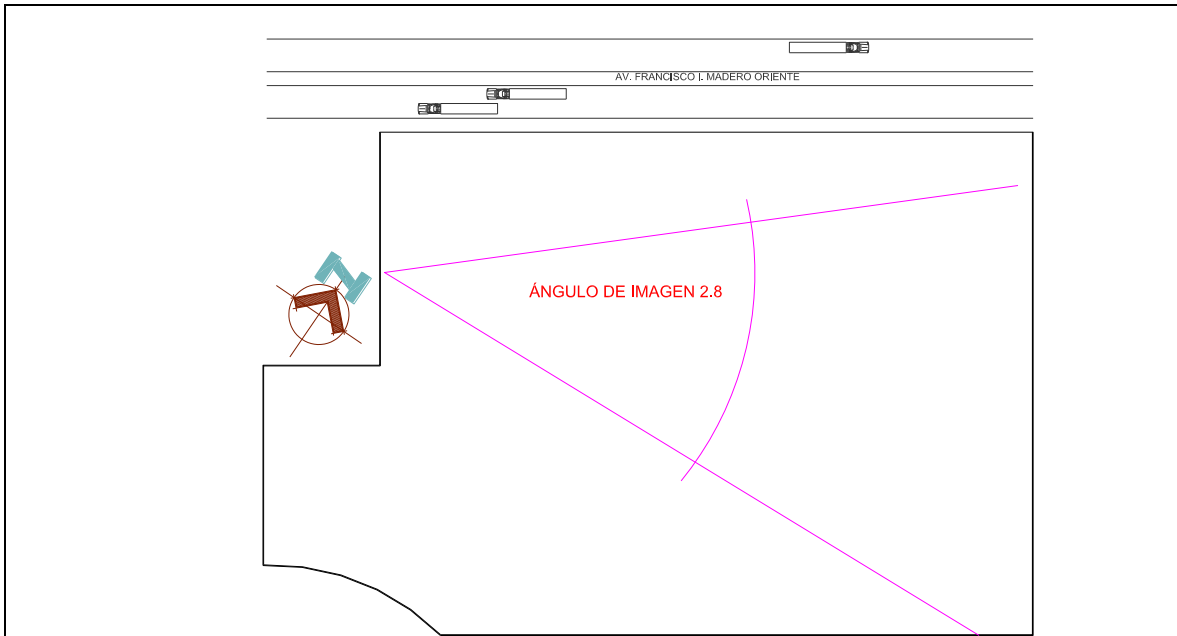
, Plano de ubicación de enfoque de cámara, vista Oriente. Fuente: Elaborada por el autor.
